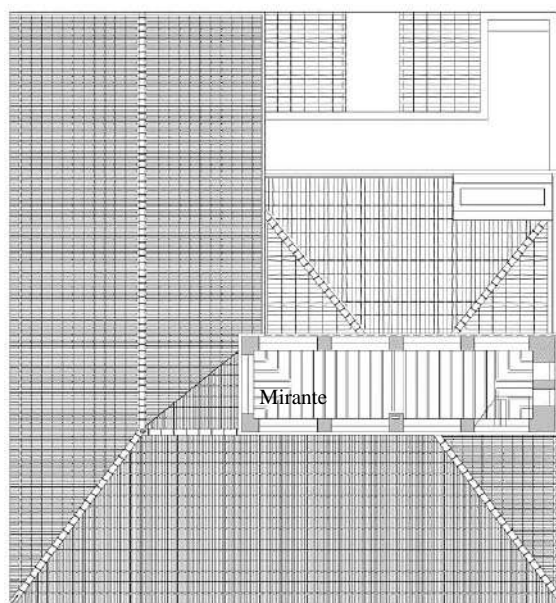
Planta terceiro piso Casa do Mirante - Existente
